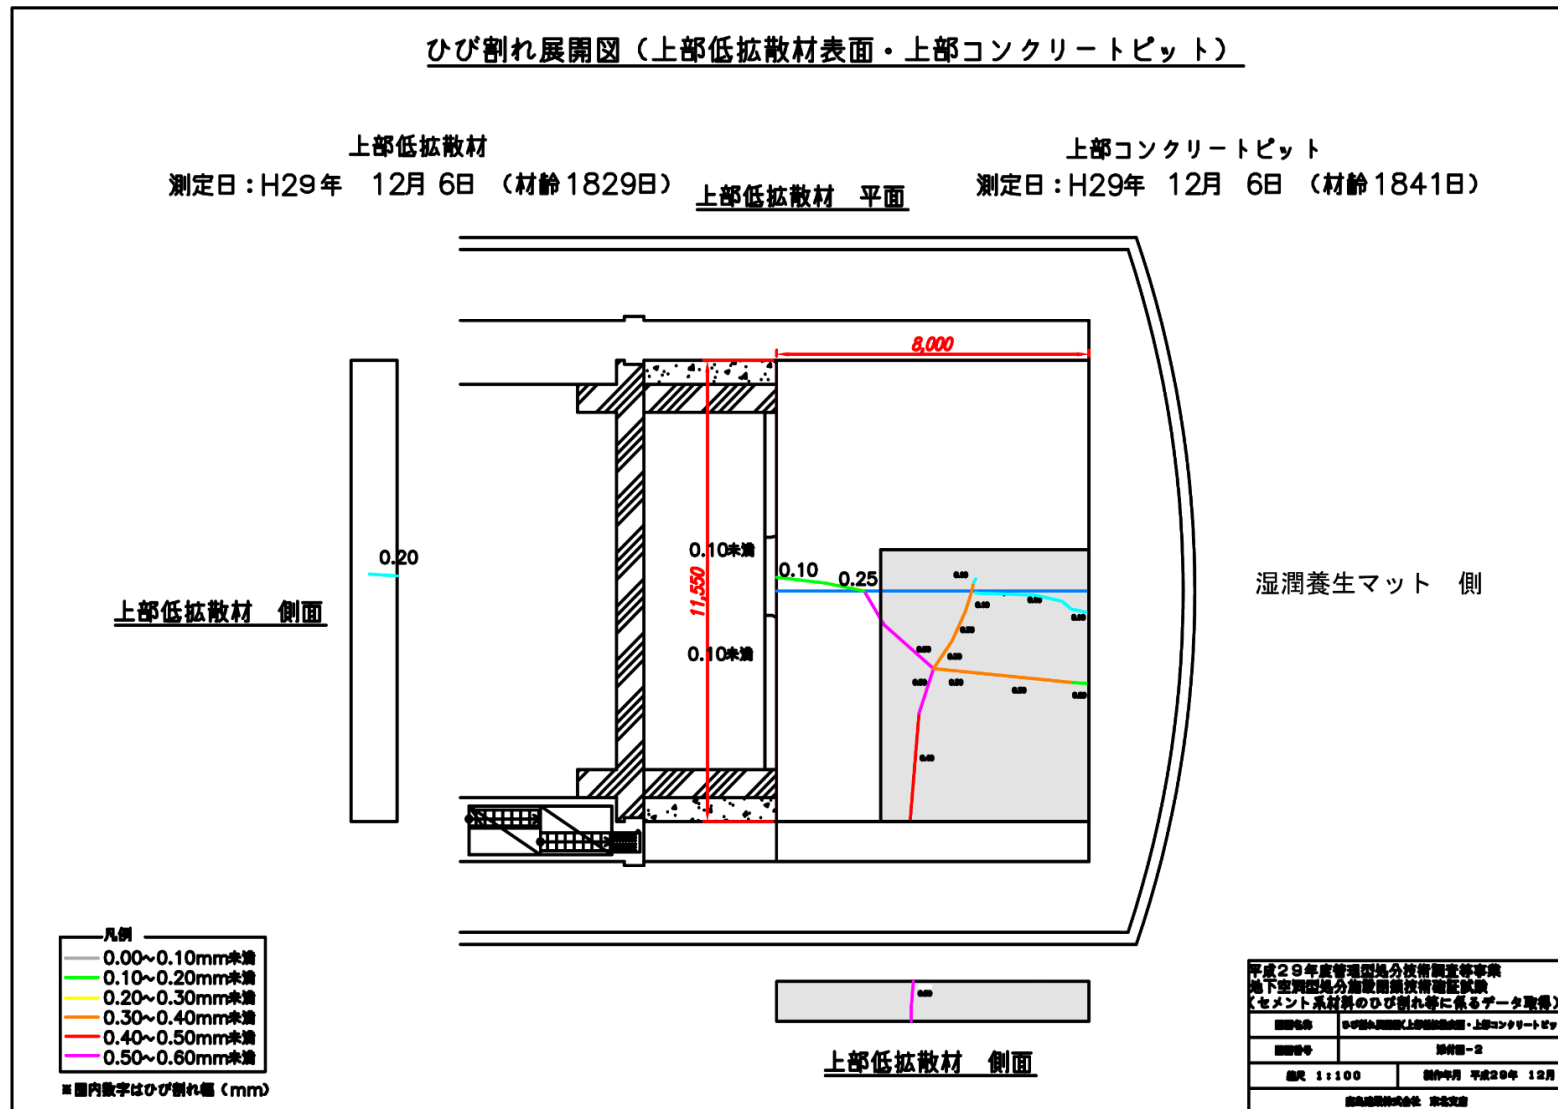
上部低拡散層および上部コンクリートピットひび割れ調査結果（平面図、側面図）
